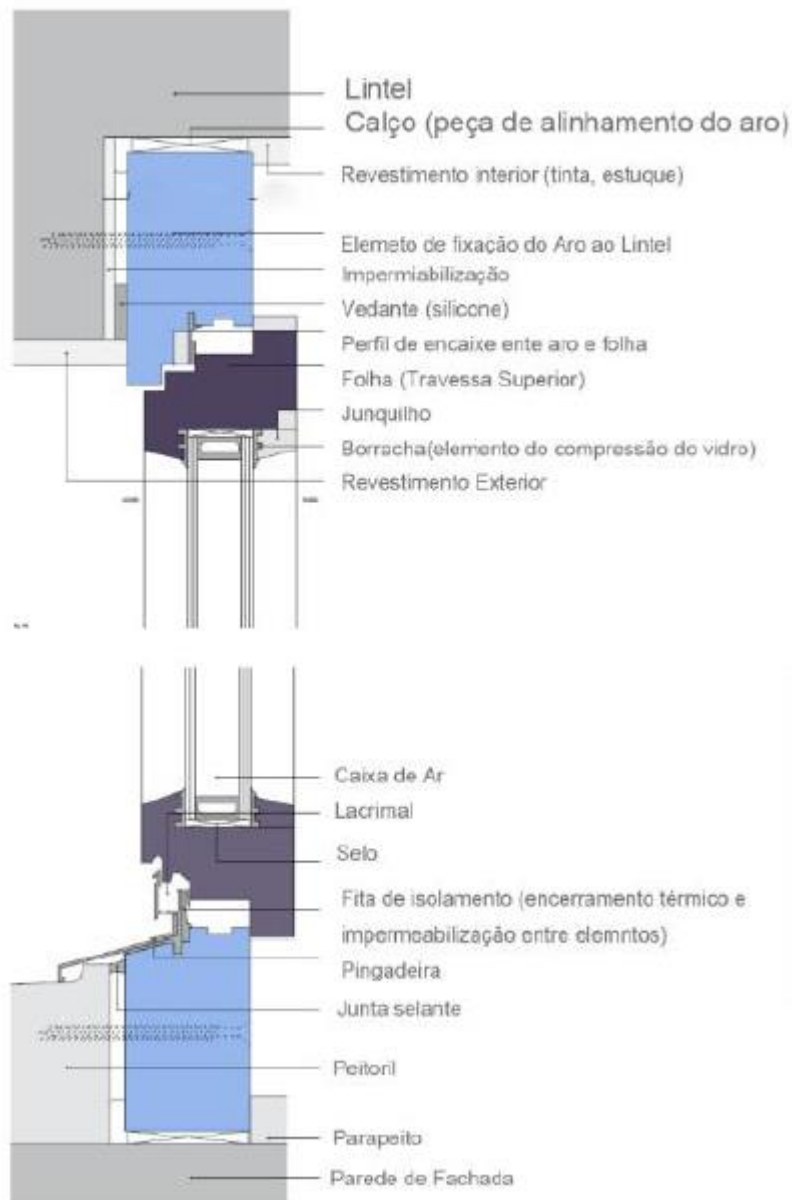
Pormenor construtivo vertical da caixilharia
